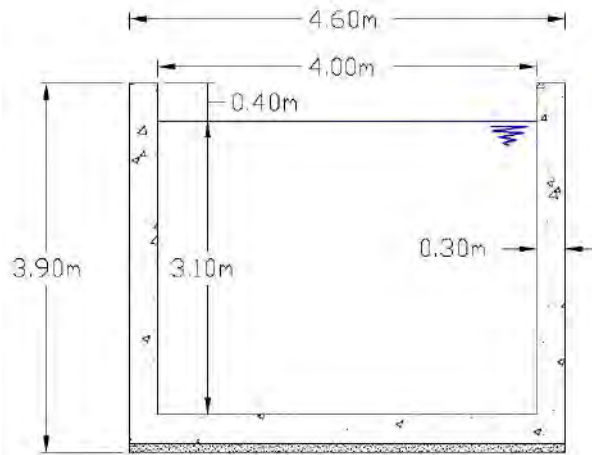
Sección típica del canal de conducción. Fuente: Propia.
